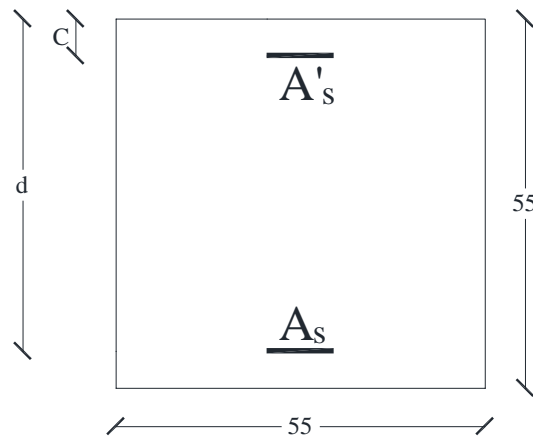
coupe d'un poteau de dimensions (55×55) cm
